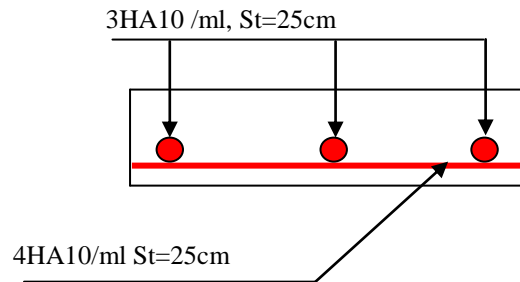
Schéma de ferrailage d'une dalle sur quatre appuis
